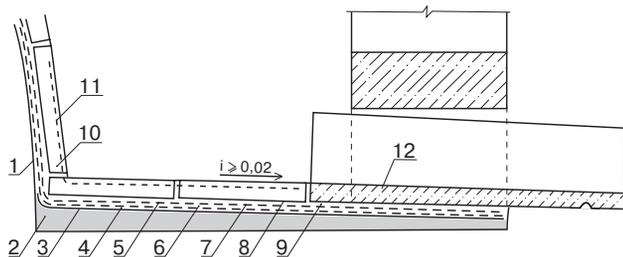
Пример конструктивного решения эксплуатируемых кровель: 1 – железобетонное перекрытие; 2 – стяжка из цементно-песчаного раствора на напрягающем цементе; 3 – грунтовка; 4, 6, 8 – мастика; 5, 7 – армирующая основа; 9 – утолщенный слой мастики или полиизоцианатный полимерраствор Лукар-ОВ; 10 – облицовка; 11 – пропитка полиизоцианатная Лукар; 12 – железобетонный водомет
